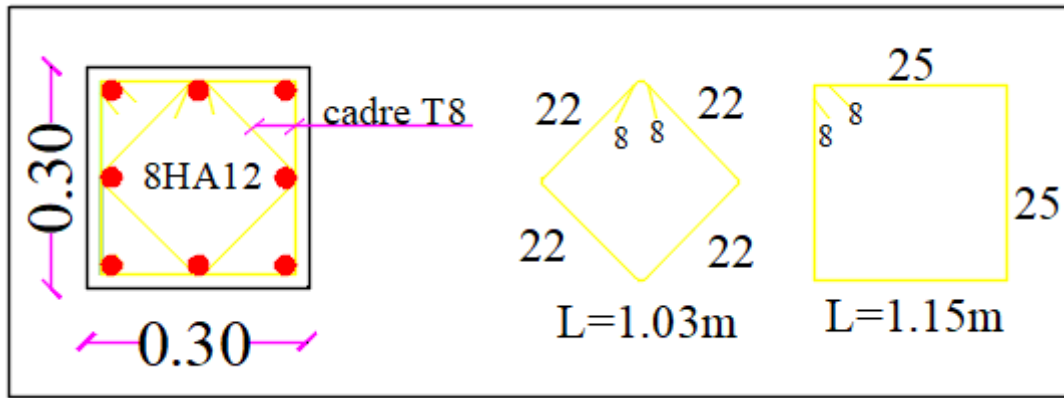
Ferraillage des poteaux 30 x 30.
